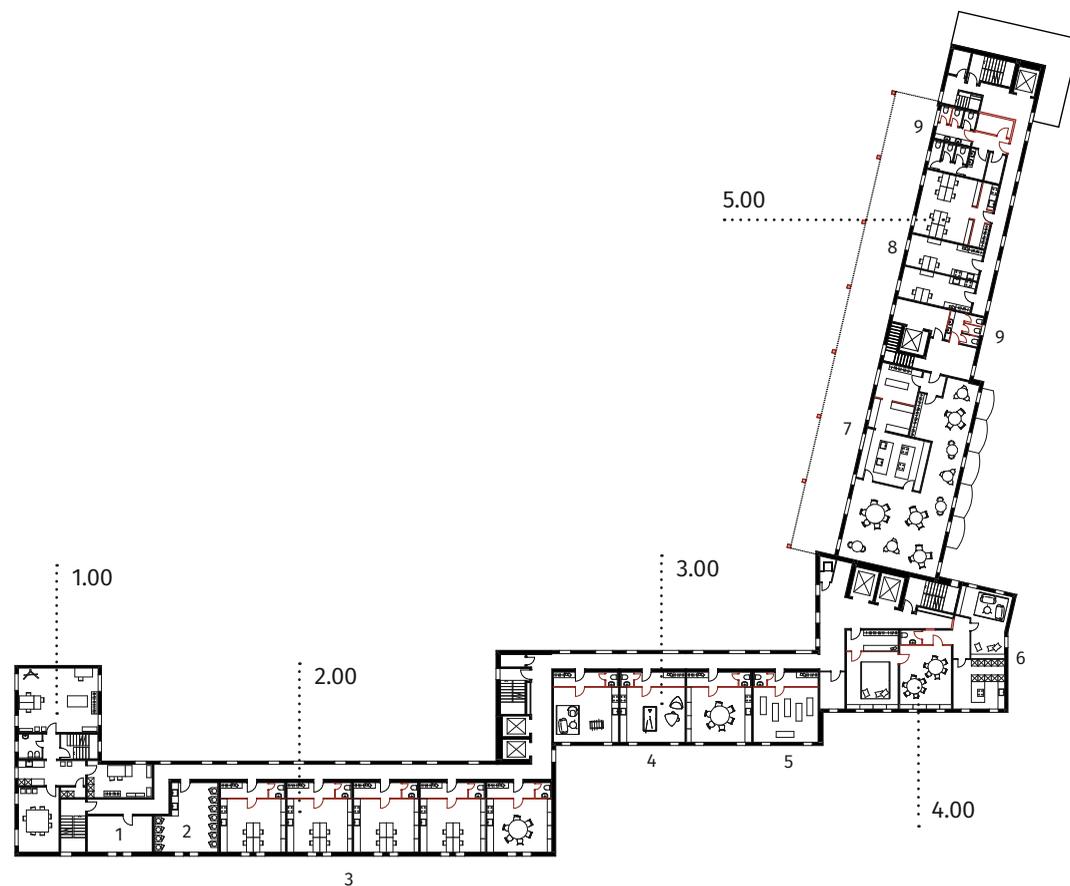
Grundriss 1. Obergeschoss, Neubau
